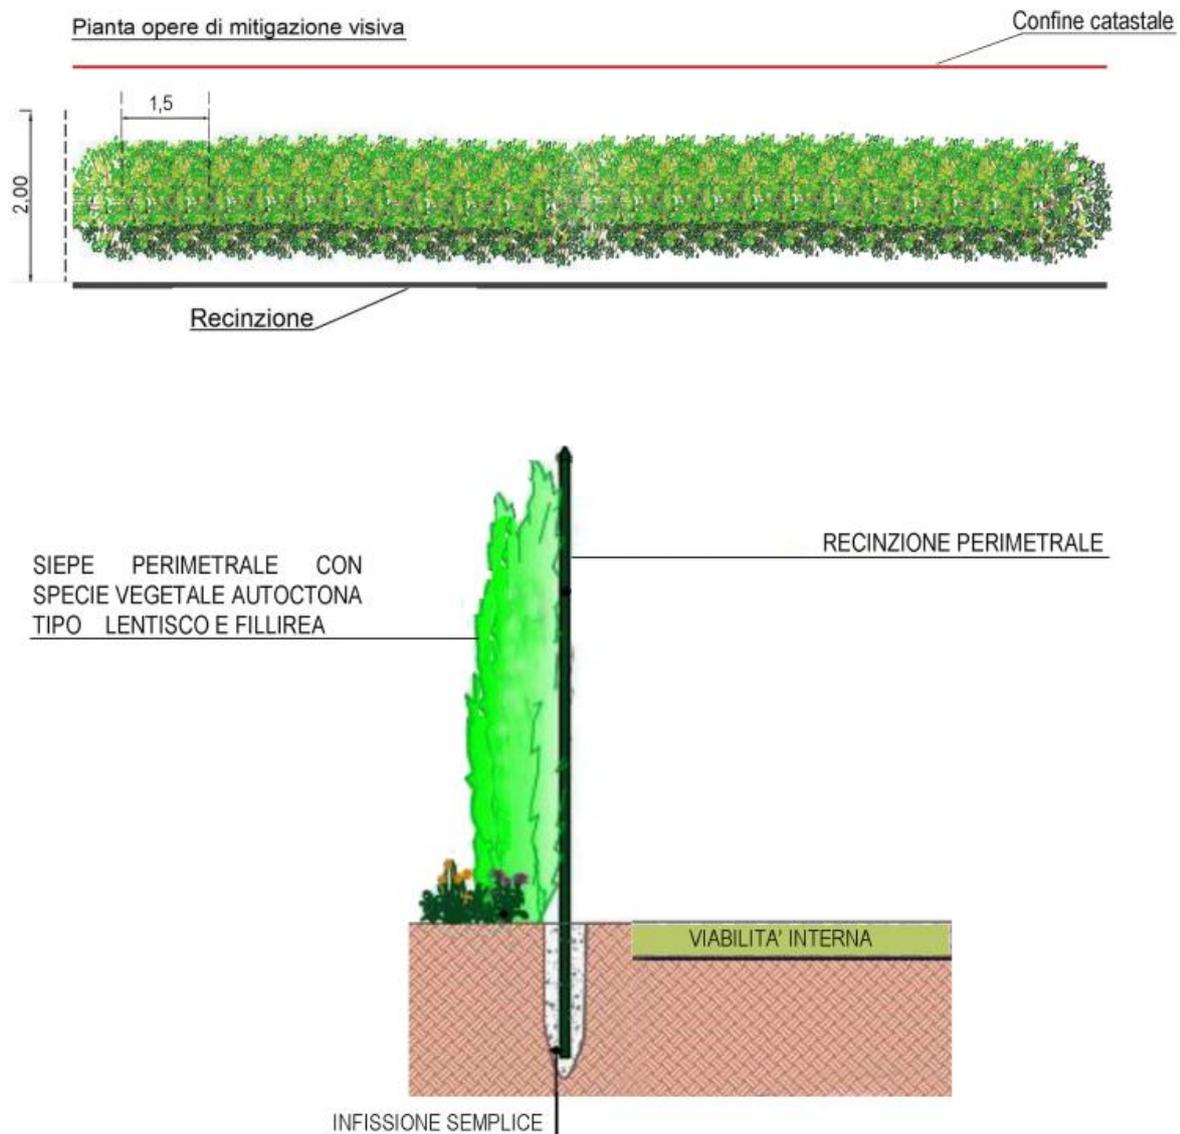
Fascia di mitigazione tipo : pianta e sezione
